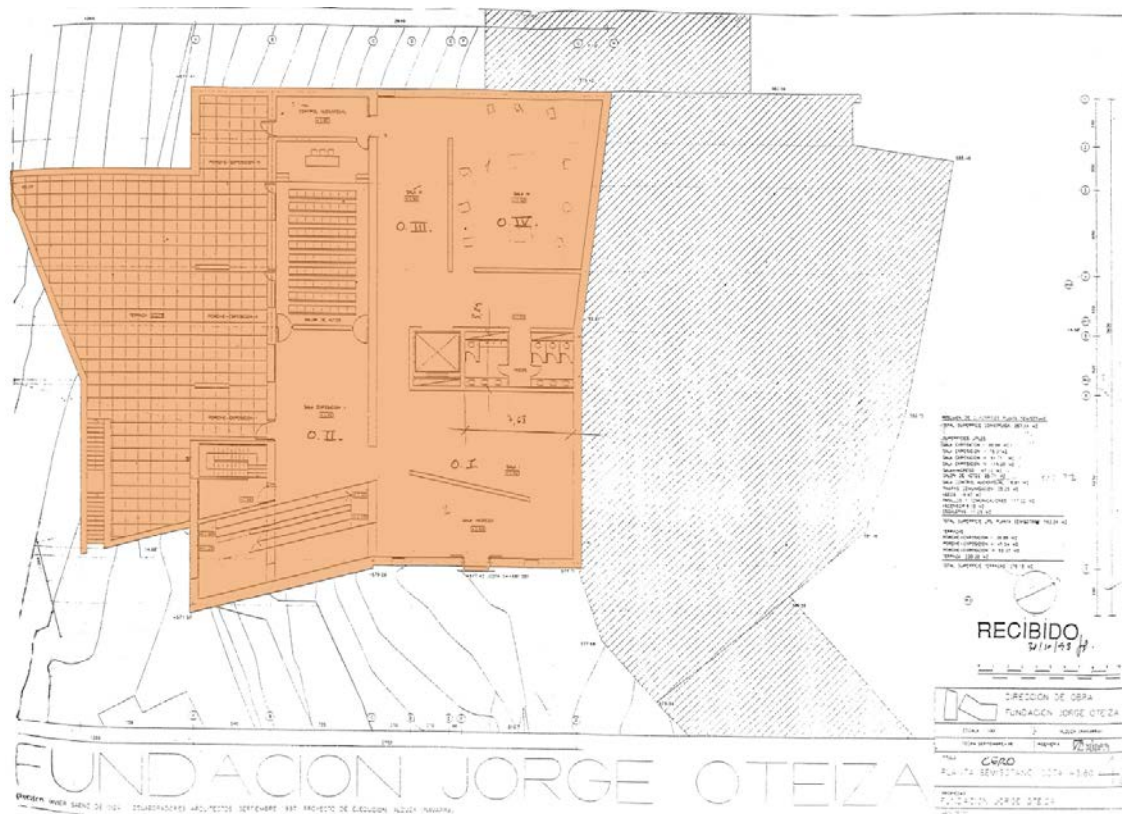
Planta 0, Fundación Jorge Oteiza. ■ exposición. S/E
